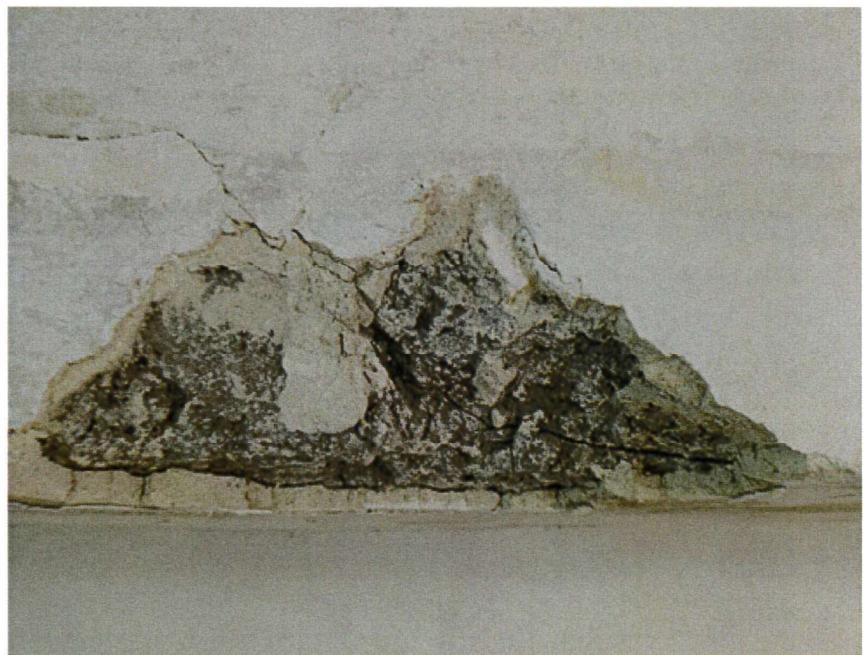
Sonda ke zjištění průběhu praskliny na styku stropního trámu a průvlaku - detail
